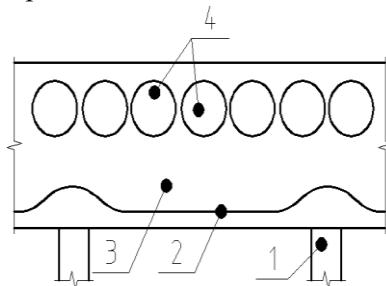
Конструктивная схема фундамента из пост-напряженных плит на свайном основании:
